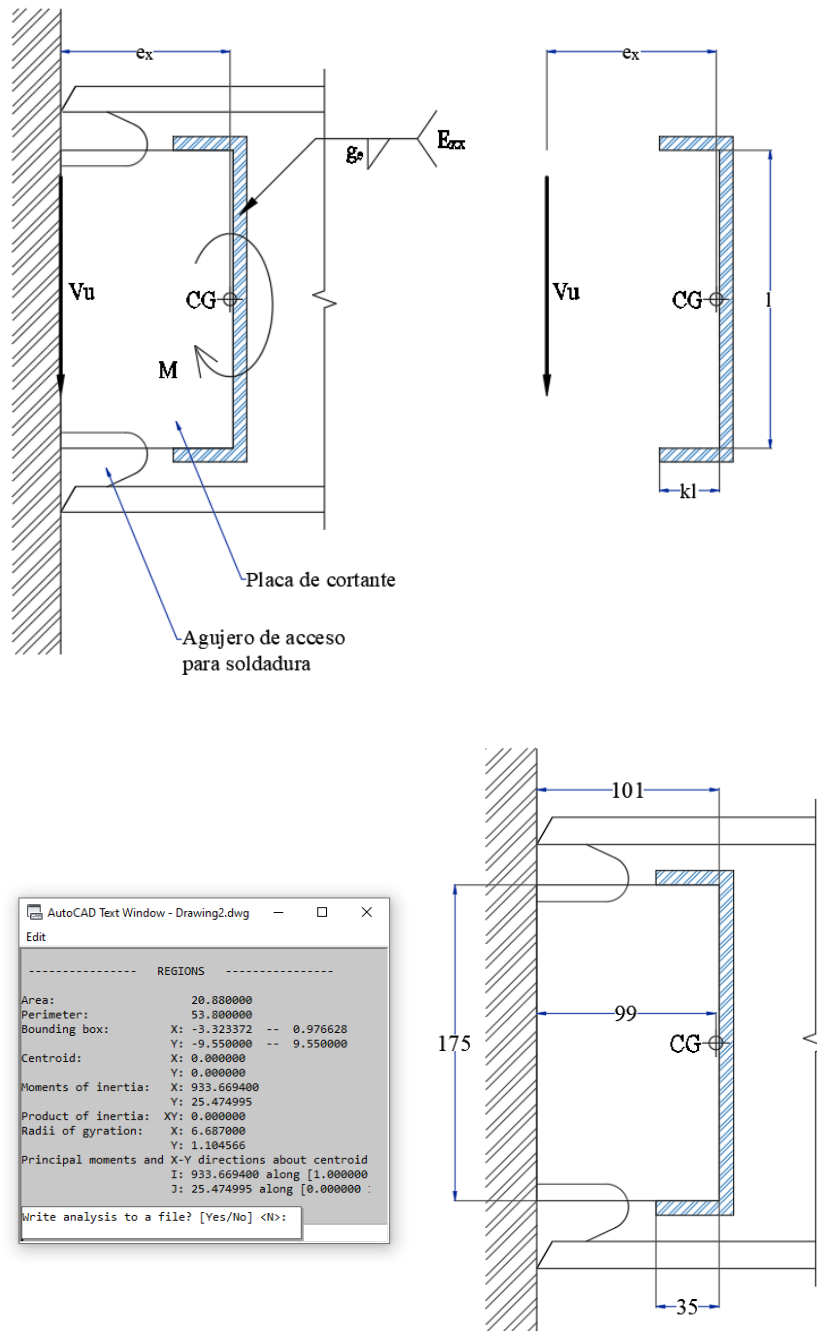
Esquema de soldadura placa de cortante (elaborado por el autor)
